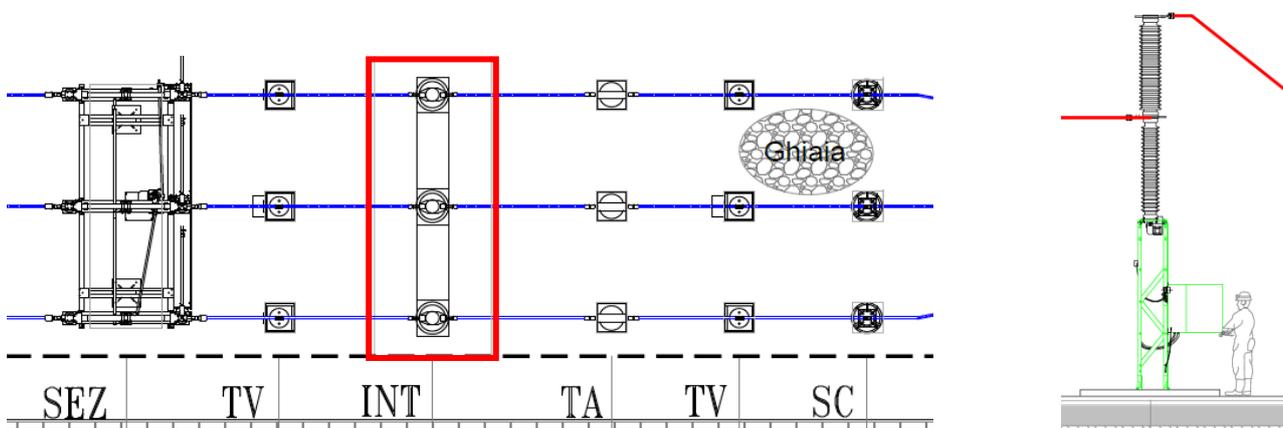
Tipico interruttore tripolare – vista prospettica e planimetrica
